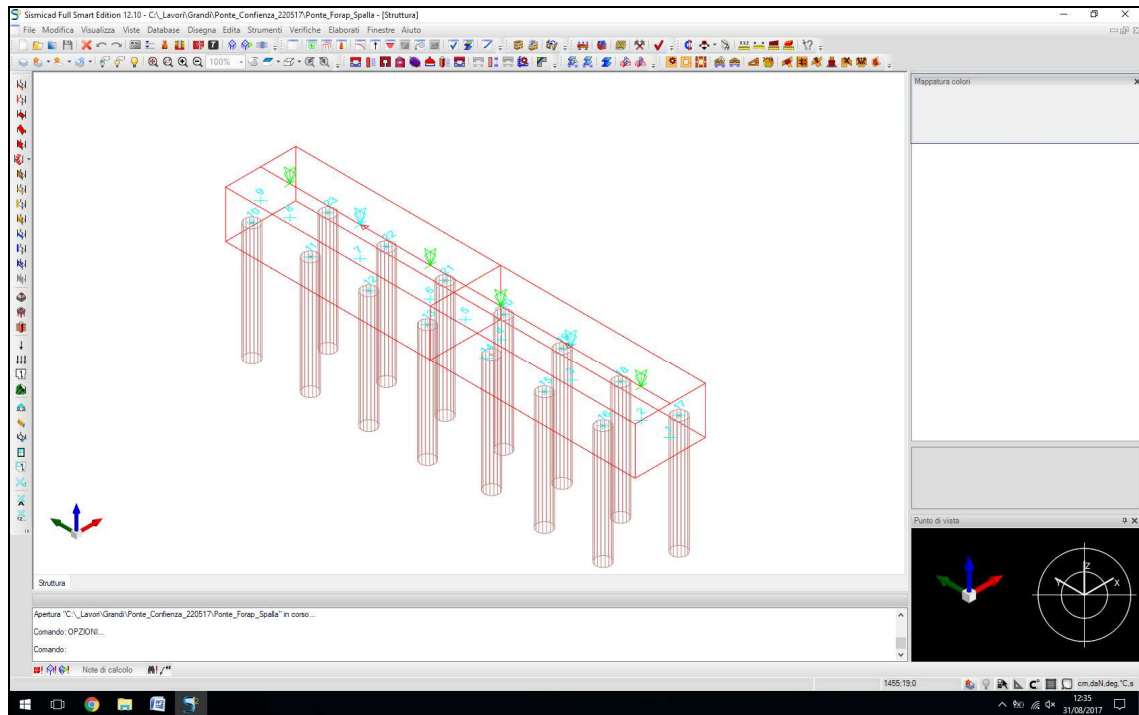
schema strutturale nuova spalla (trave di testata - micropali)
